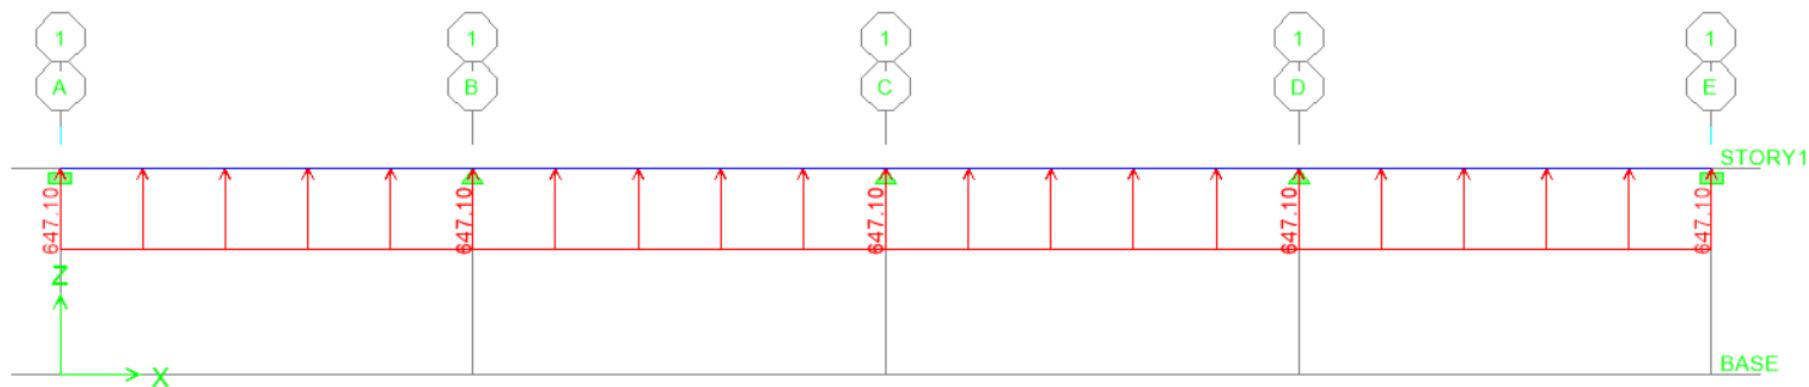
Schéma statique de la nervure ELU (sens transversal).
